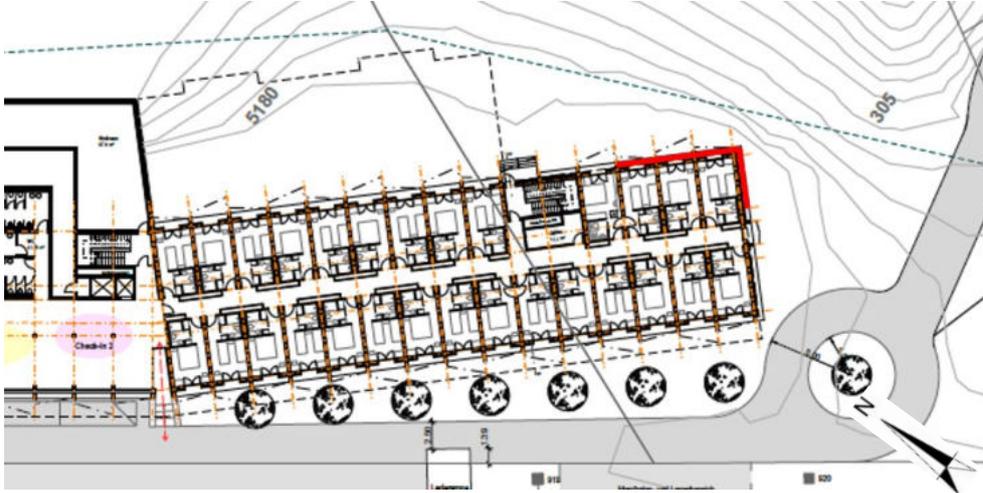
Östliche Gebäudeecke mit der erforderlichen Verstärkung der NO- und SO-Fassaden (rot).
